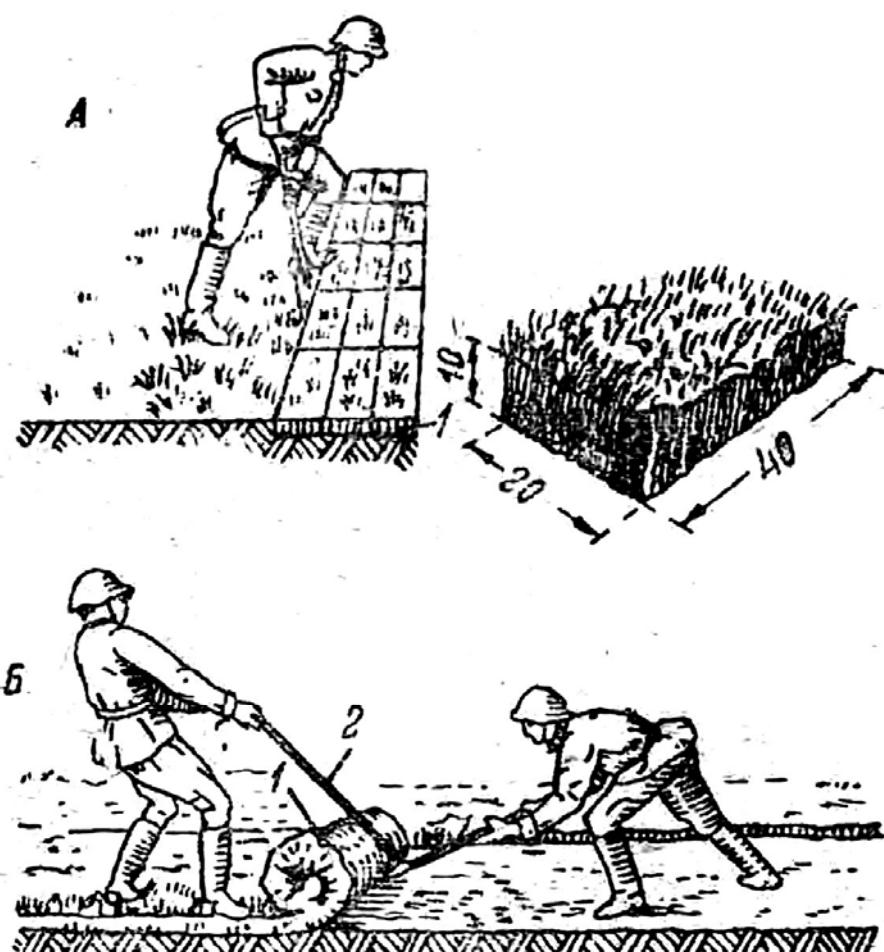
Дерн и его заготовка дернинами (А) и рулонами (Б).
